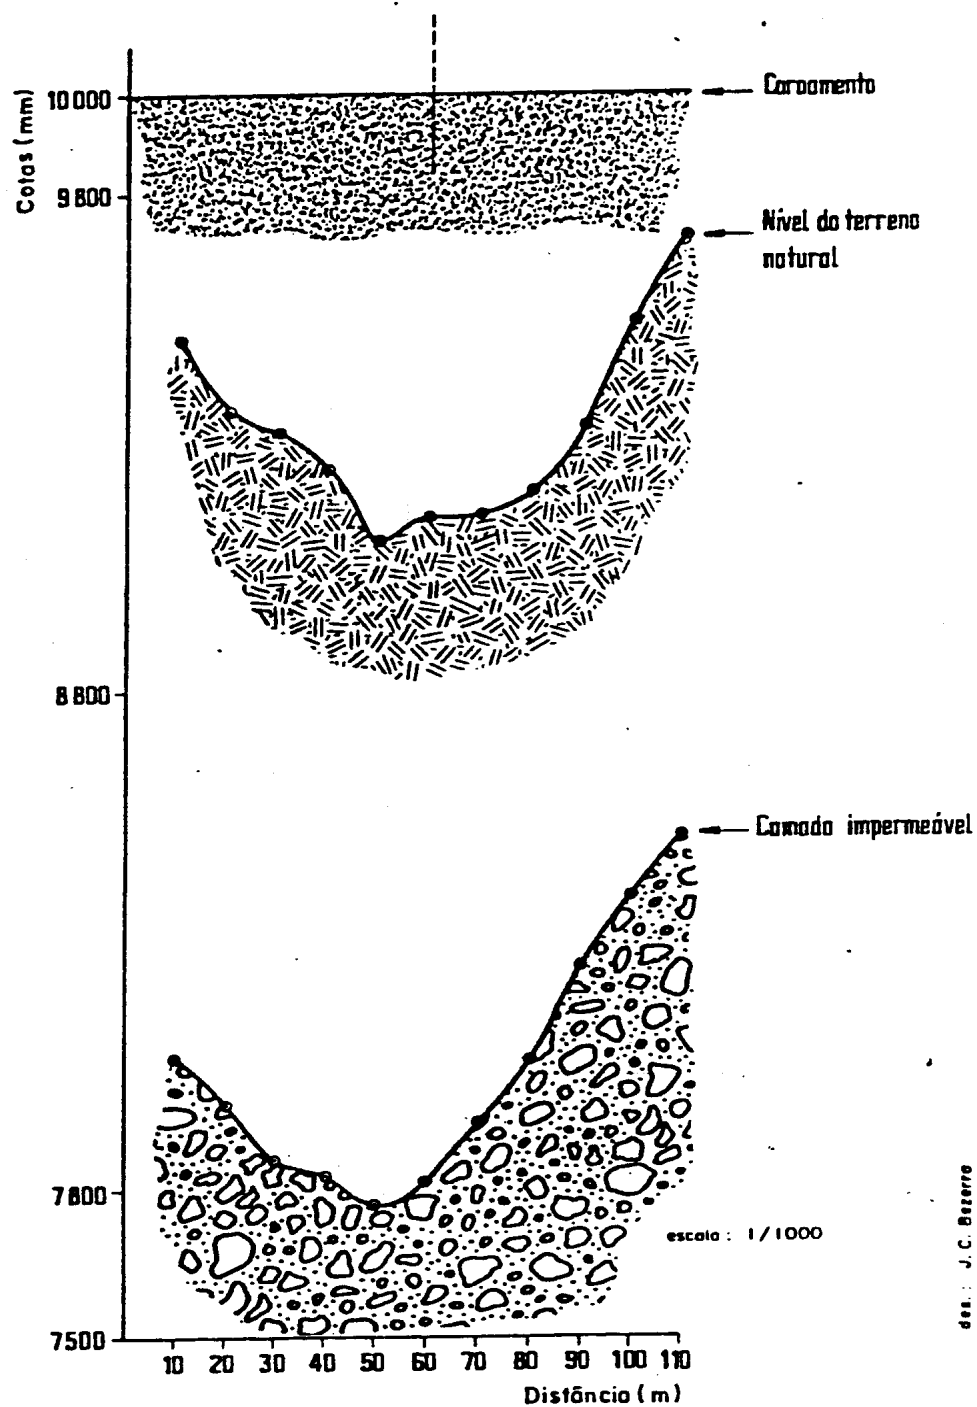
Perfil do terreno e da camada impermeável da Barragem subterrânea³ 3.
